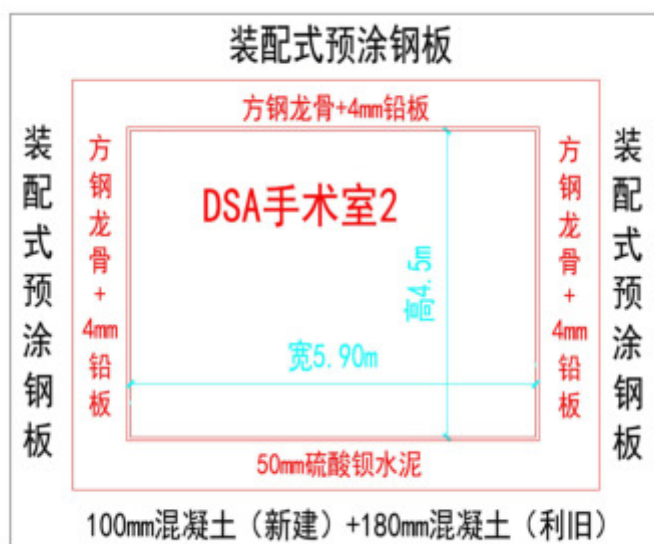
本项目 DSA 手术室四周墙体防护结构剖面图
